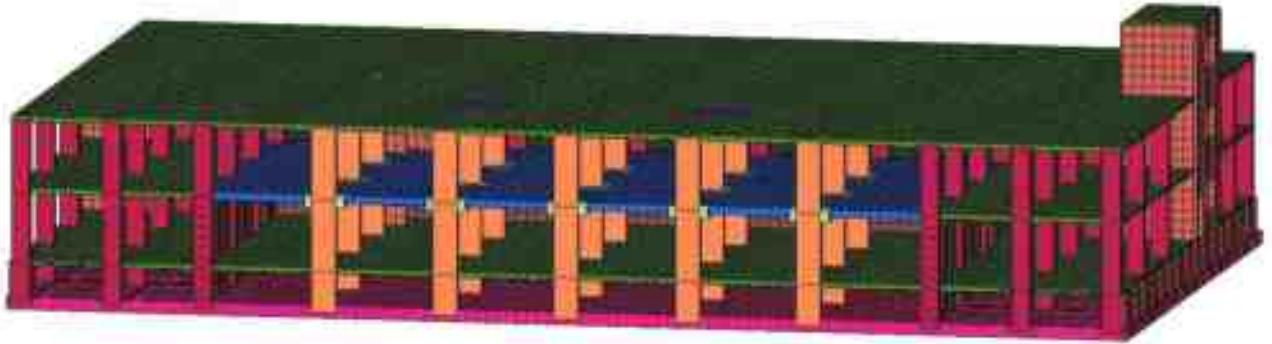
Розрахункова модель будівлі (вид 1)
